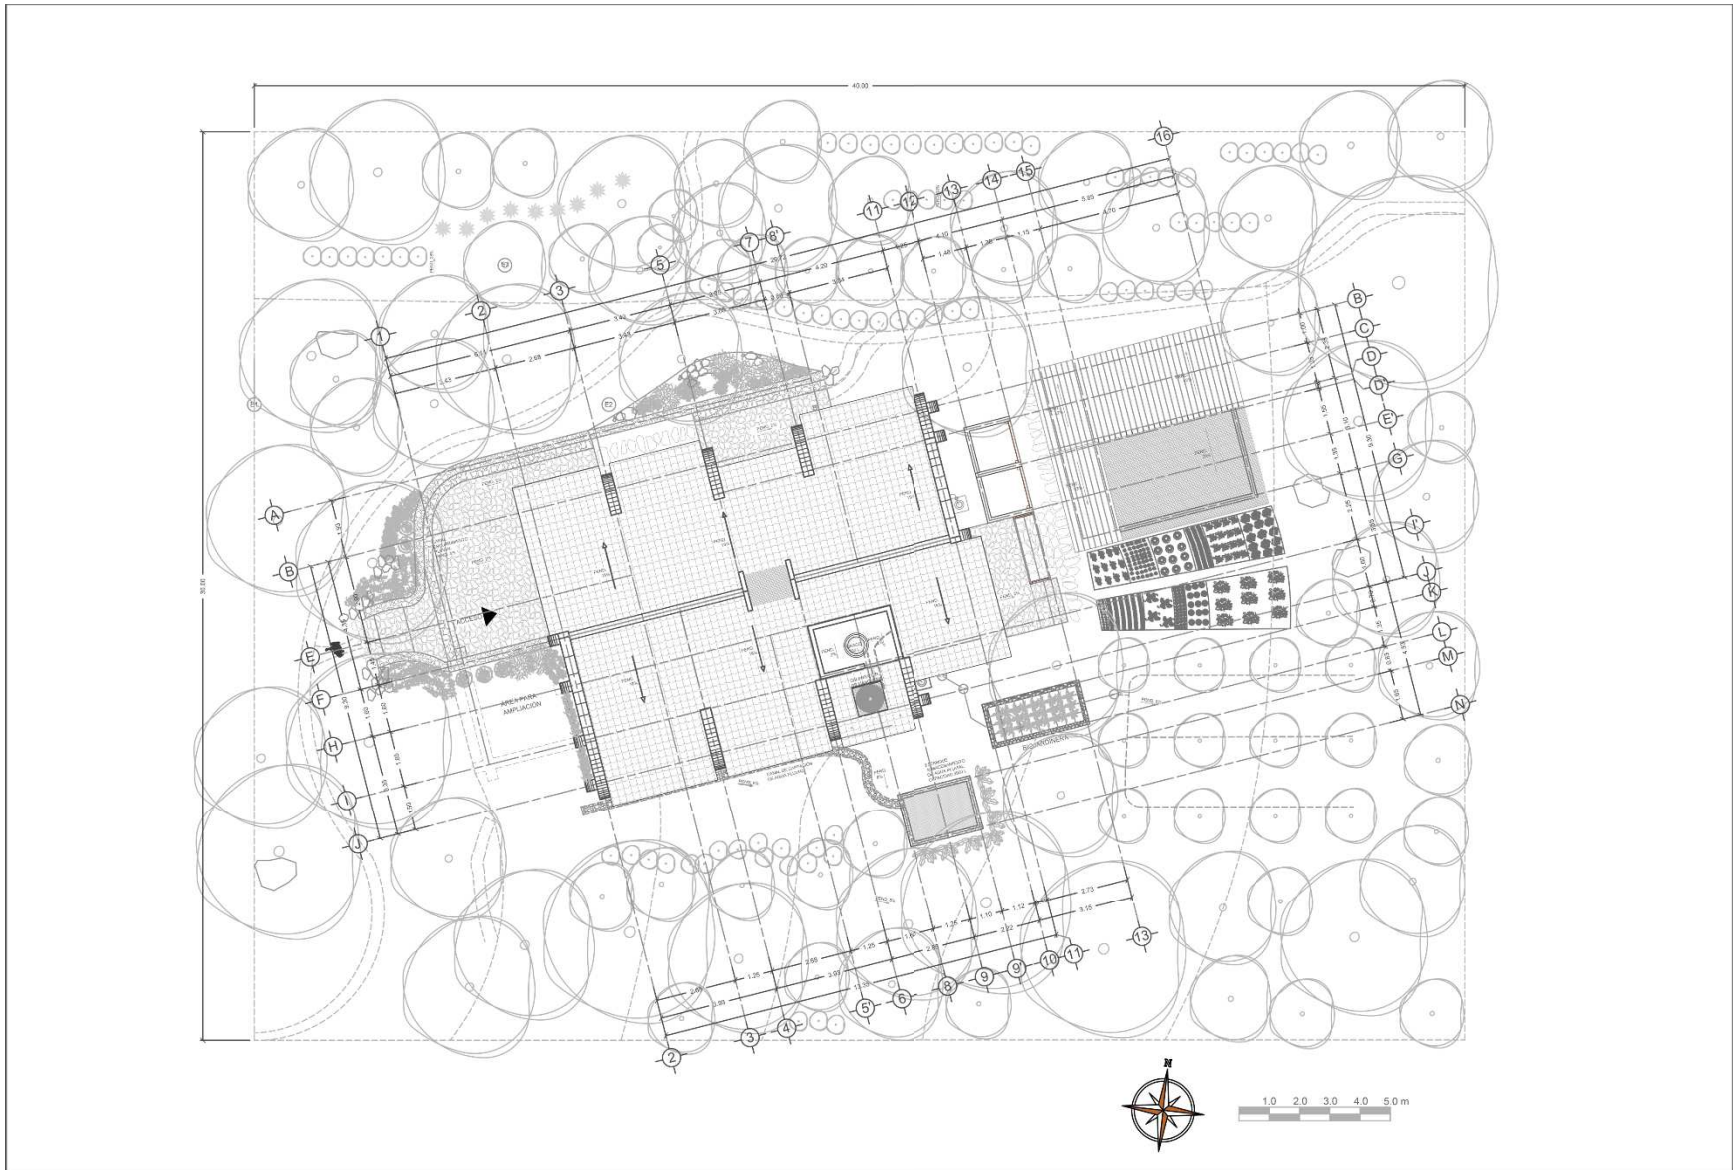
Planta de conjunto de la casa autosuficiente. Sin escala.
